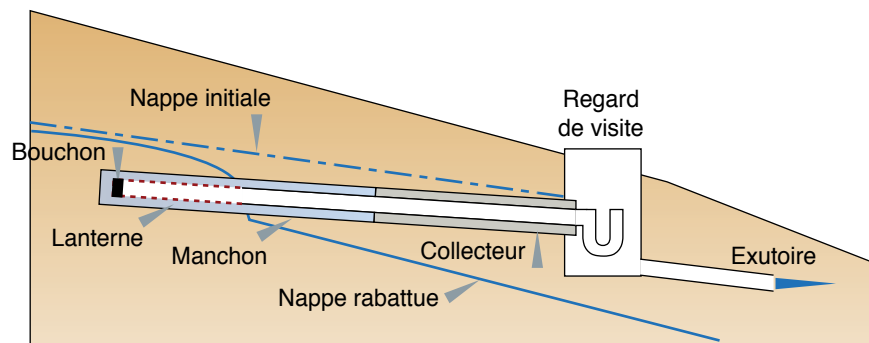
Schéma d'un drain subhorizontal ascendant (lanterne drainante, puis manchon étanche, puis collecteur avec fonction d'accumulation). D'après document J.-C. Gress.
